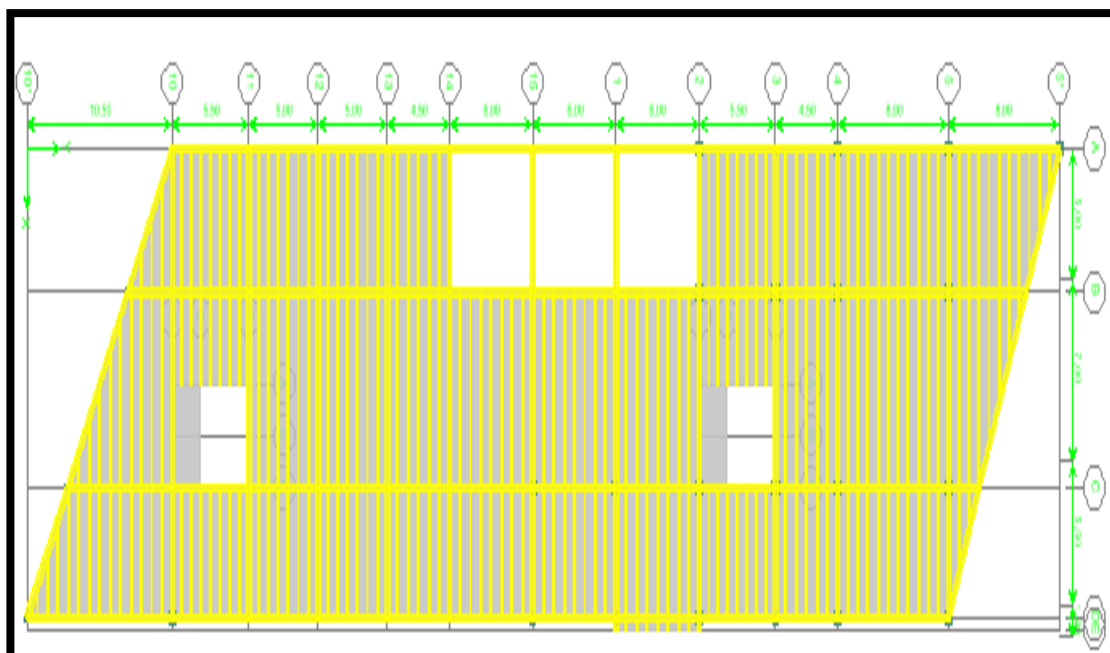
Planta tipo Edificio Norte (Nivel 1)
